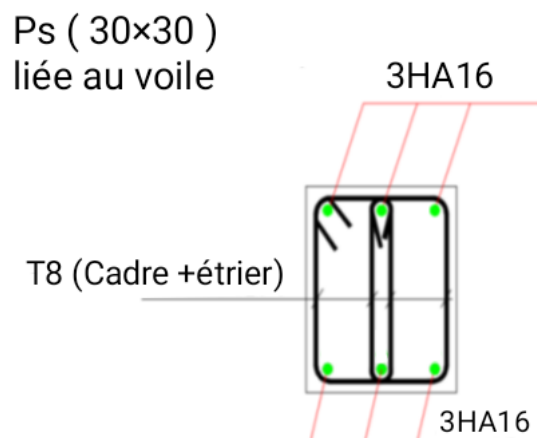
Schéma de ferrailage de la poutre secondaire liée au voile
